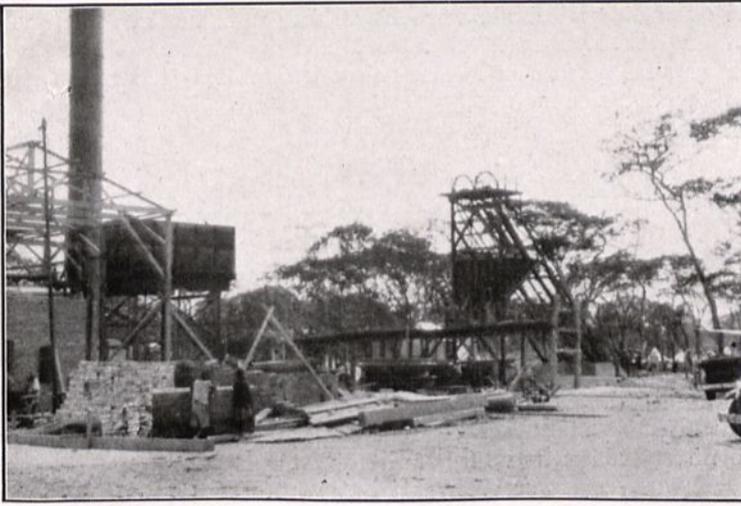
Roan Antelope. Schacht II; Fördermaschinenhaus im Bau (Sept. 1929). (Aufn. Schneiderhöhn)
